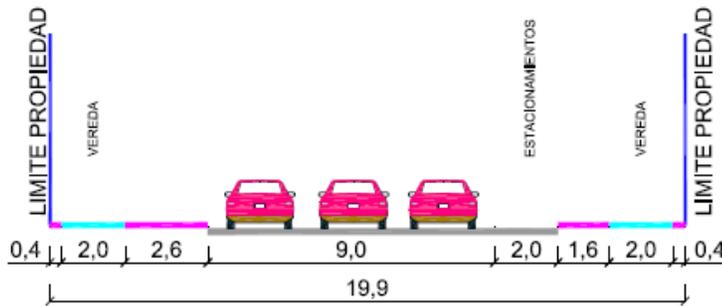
Perfil Tipo Av. O’Higgins, San Ernesto - Caupolicán
